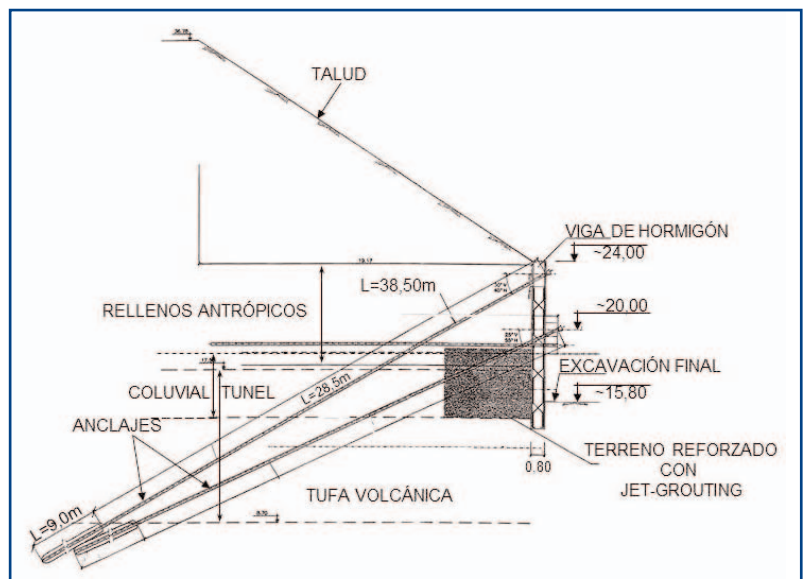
Sección longitudinal al túnel en la zona del emboquille lado mar.
